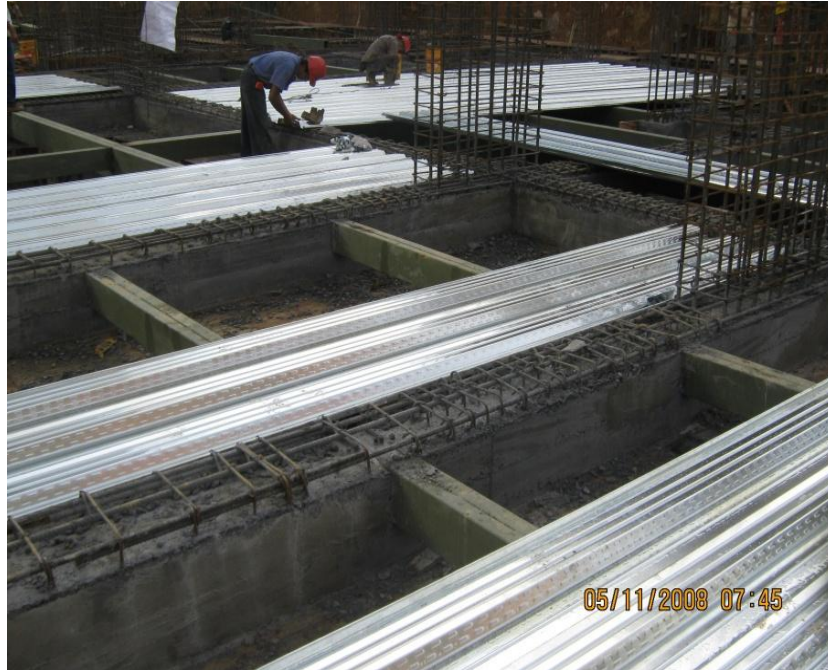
Instalación de la lámina colaborante. (Steel Deck)
